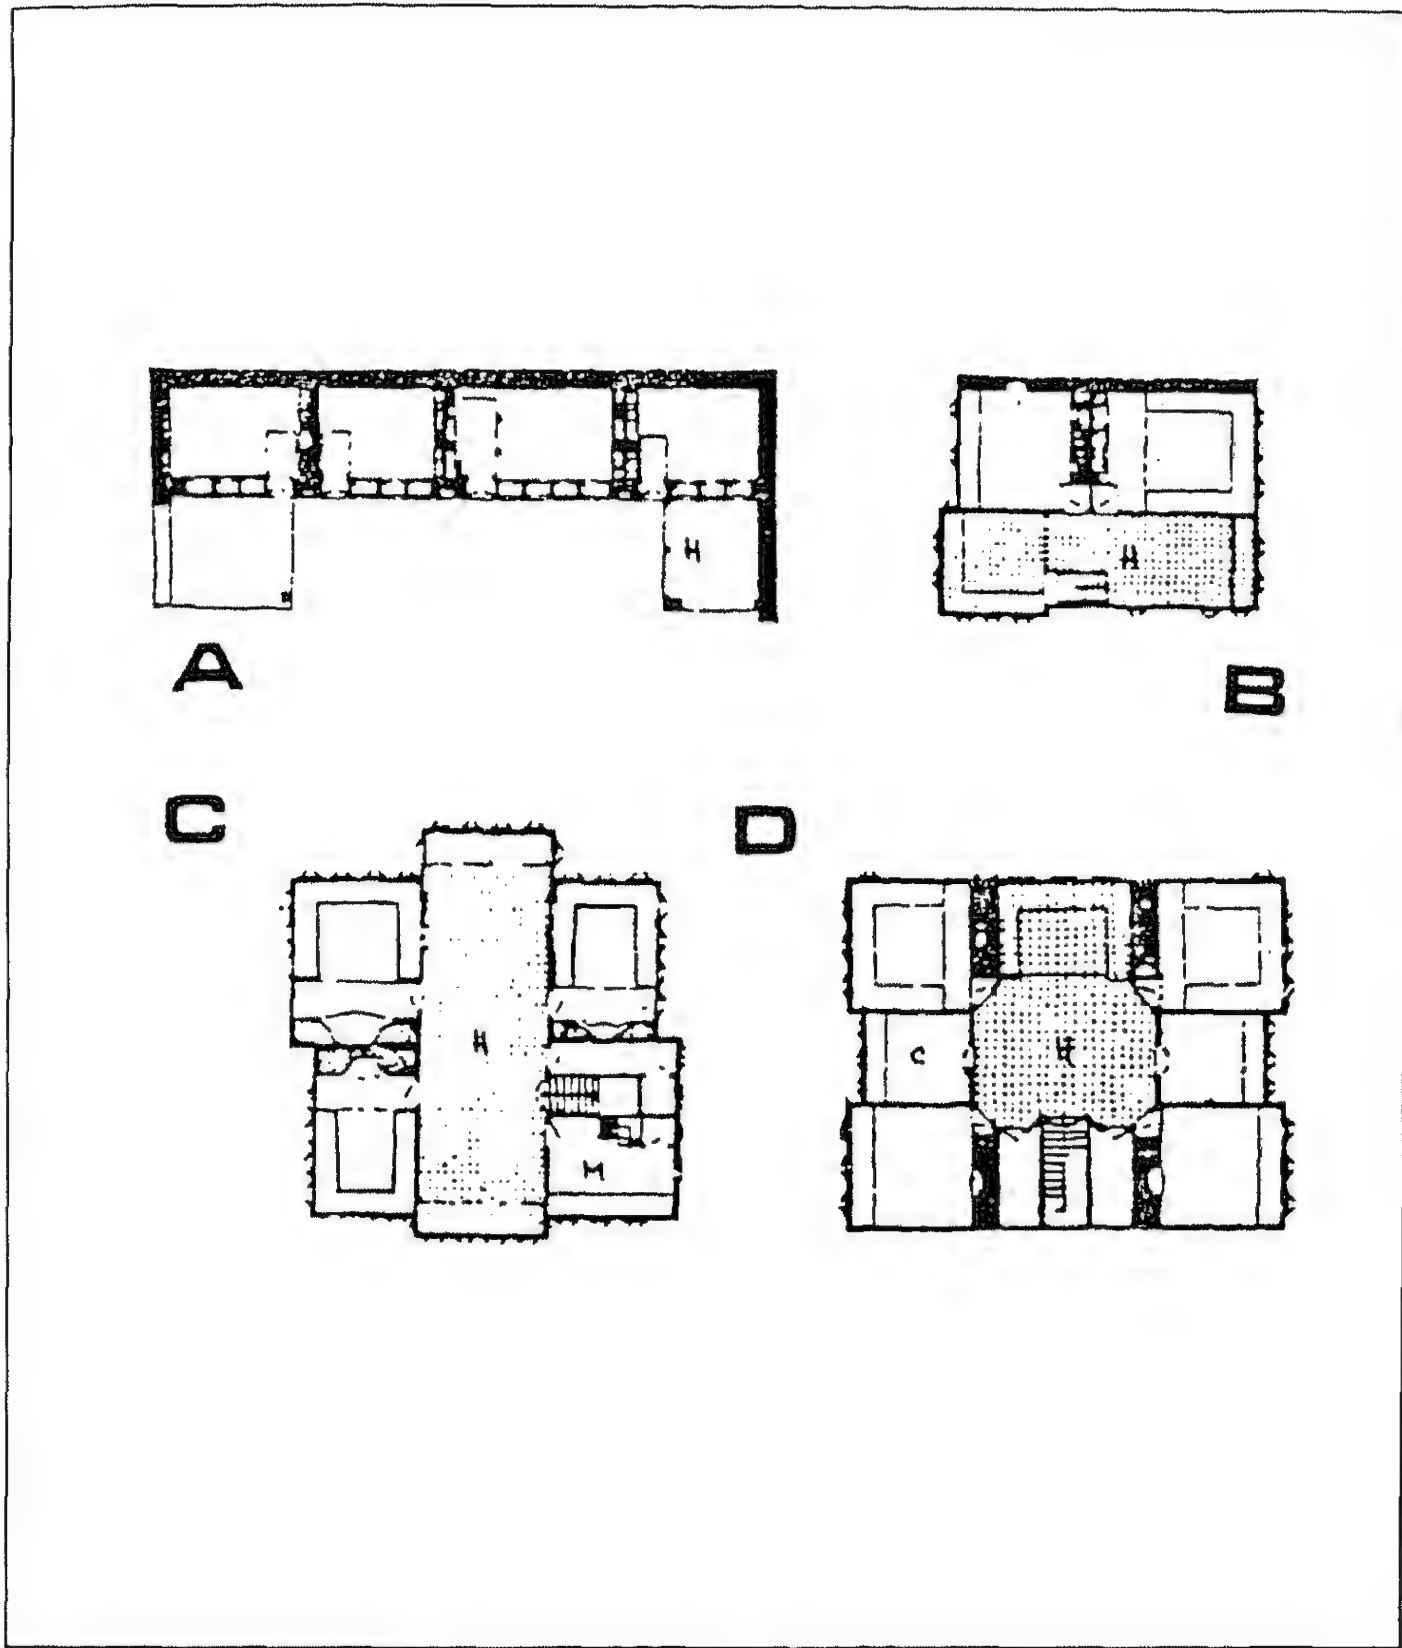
مكرر) مسقط أفقي للطابق الأرضي للحرم ملك بطوب قابي سراي
